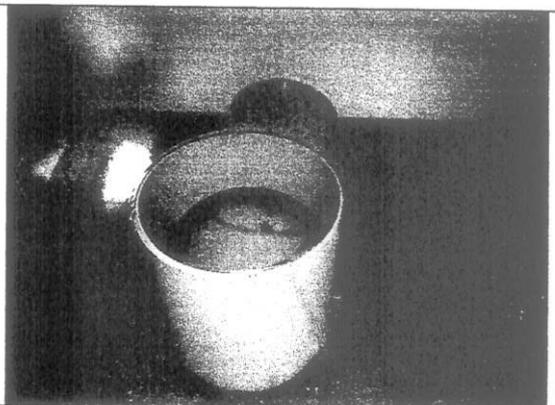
Ponto de extravasão elevado à pequena altura através de tubo conectado ao duto principal.
